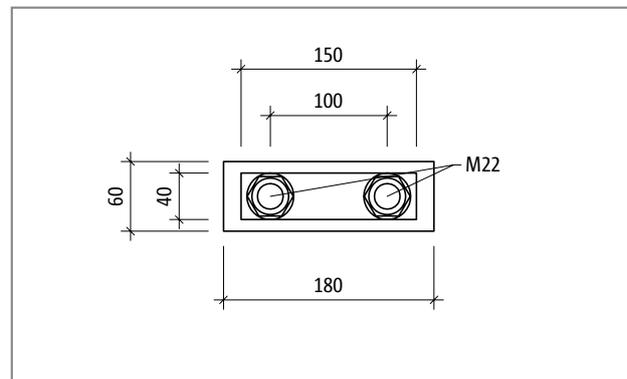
Schöck Isokorb® T type S-N-D22: Product elevation
